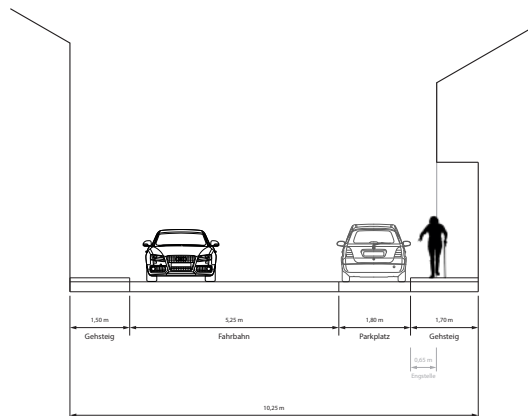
Schnitt Hauptstraße nahe Kreuzung mit Kremsergasse. Quelle: eigene Darstellung
